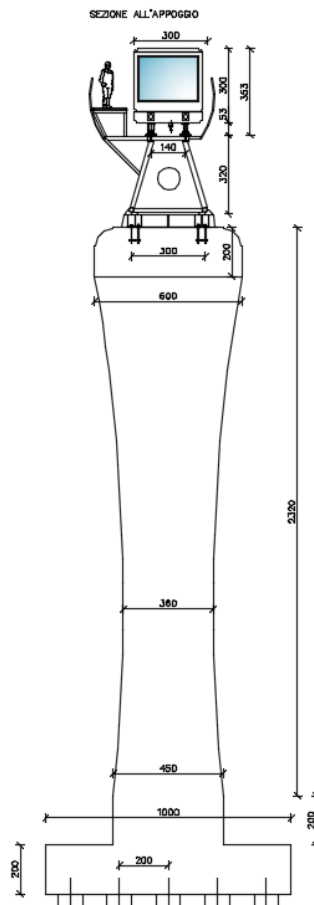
Sezione trasversale dell'impalcato in appoggio (con pila)
